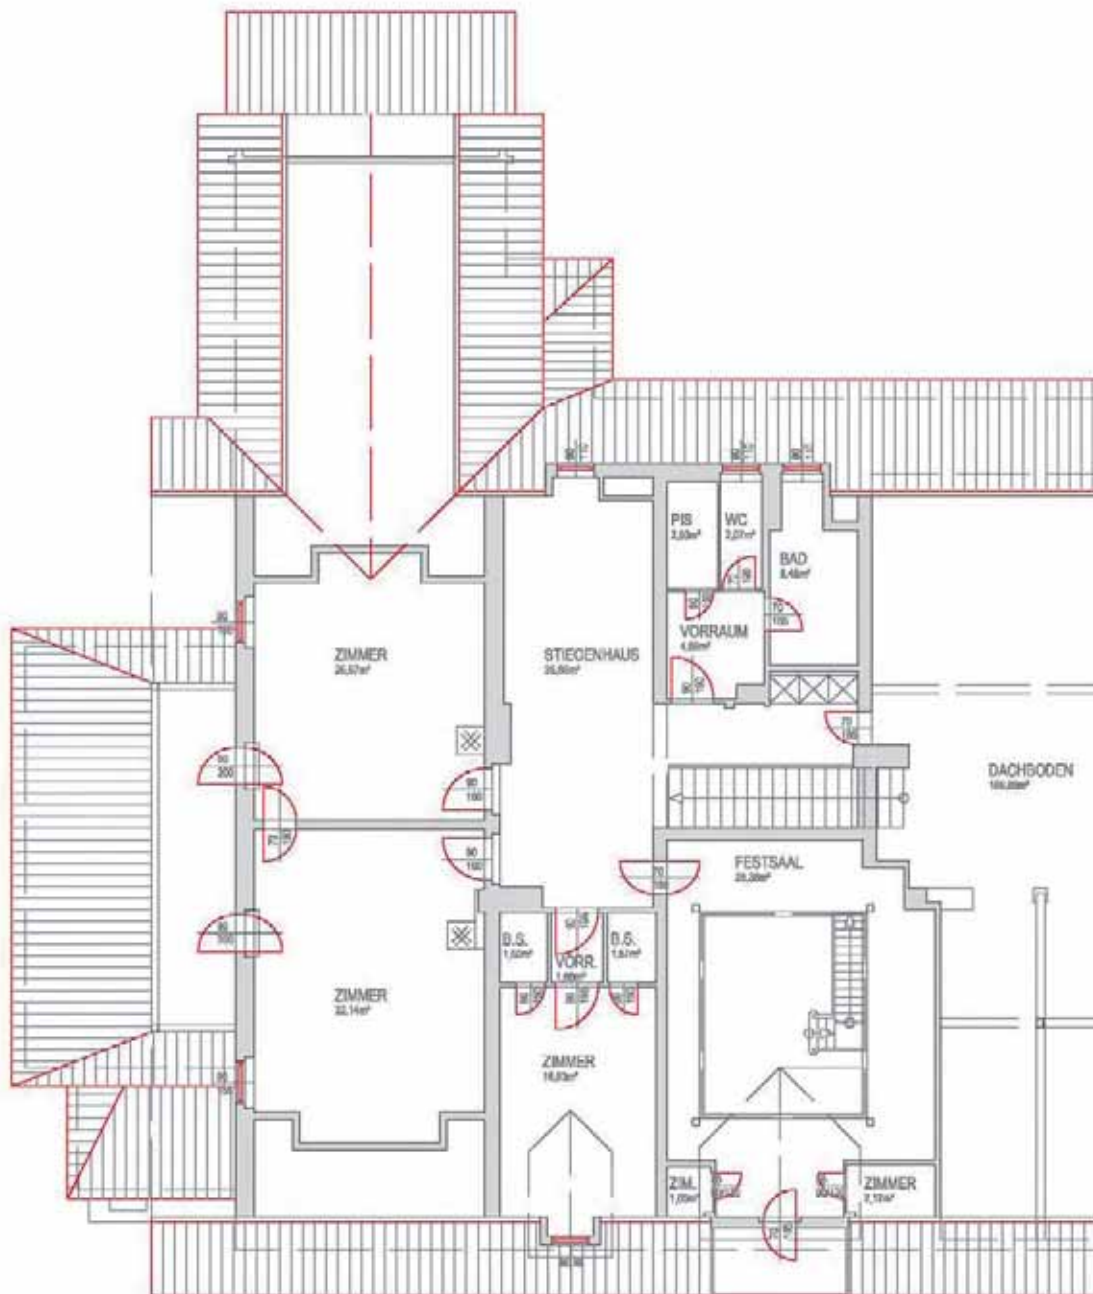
Schadensanalyse Dachgeschoss, südlicher Teil
